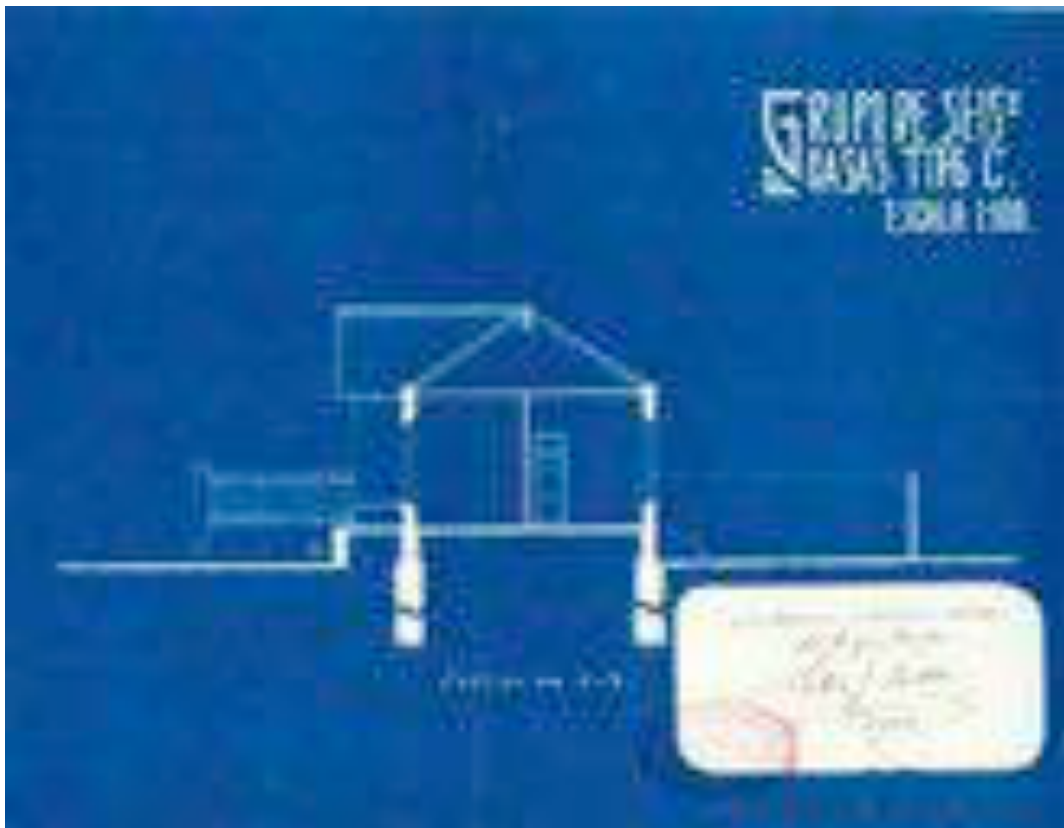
'Grupo de seis casas tipo 'C'. Plano de sección. V. Beltrí. 1927. ACMF CB 172/2.
